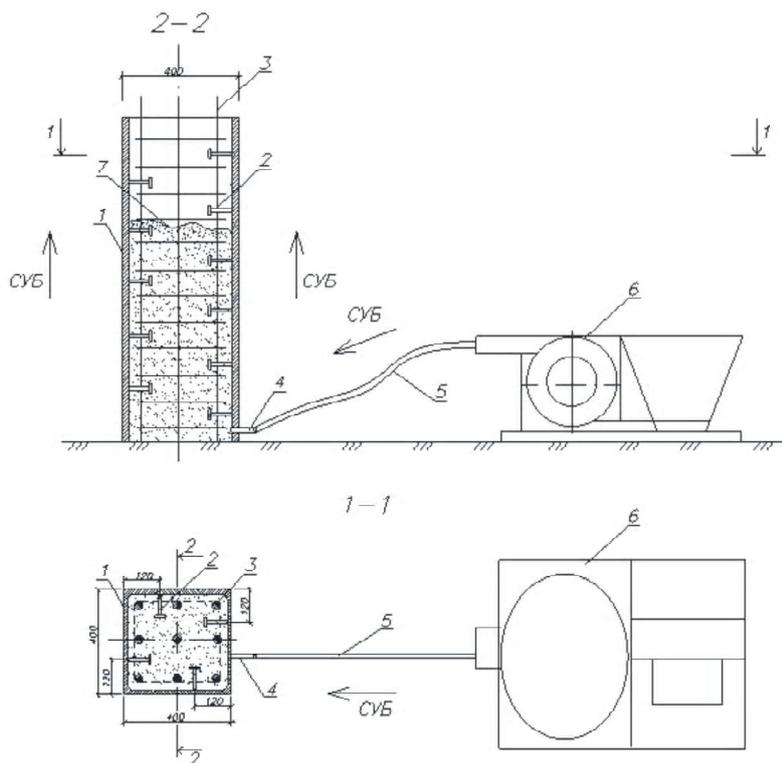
Бетонирование сталежелезобетонной колонны: 1 – арматура-опалубка; 2 – анкерный упор; 3 – продольная гибкая арматура; 4 – штуцер; 5 – шланг для подачи бетона; 6 – роторный насос; 7 – самоуплотняющийся бетон.
